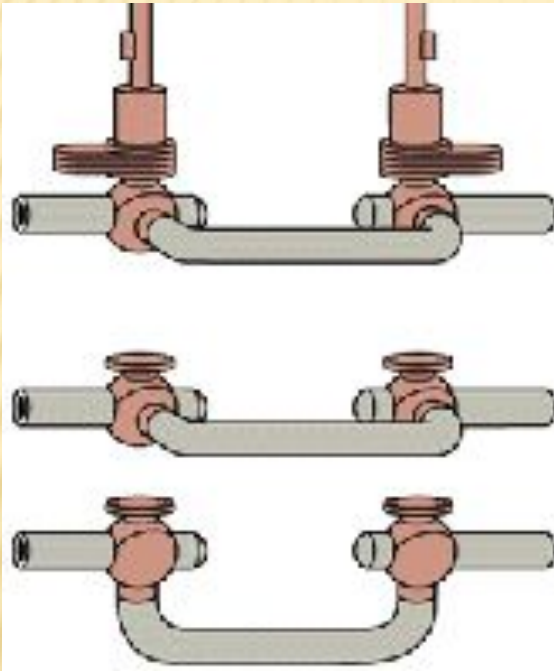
Перекрытие с двух сторон с помощью устройства. Рис.2.6. Перекрытие с двух сторон. Установка линейной задвижки. Рис.2.7. Перекрытие с двух сторон. Вырезка дефектного участка.
